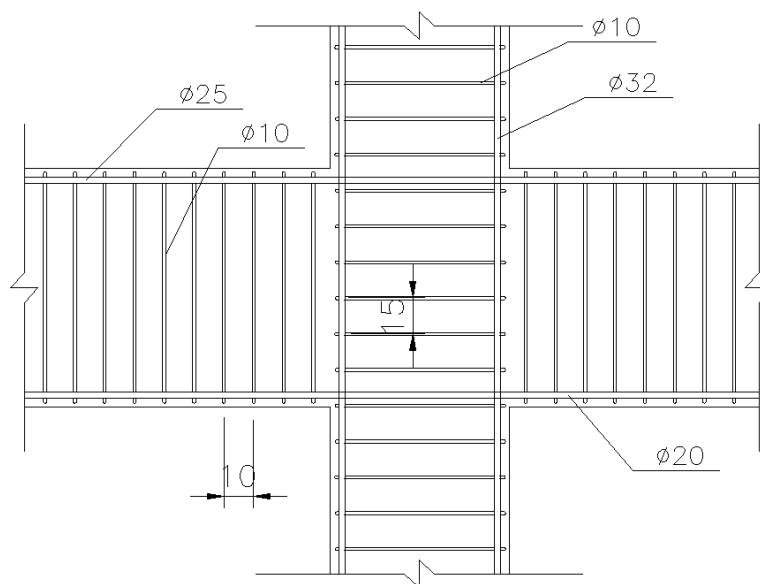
Detalhe do estribo do pilar passando pelo nó viga-pilar.
